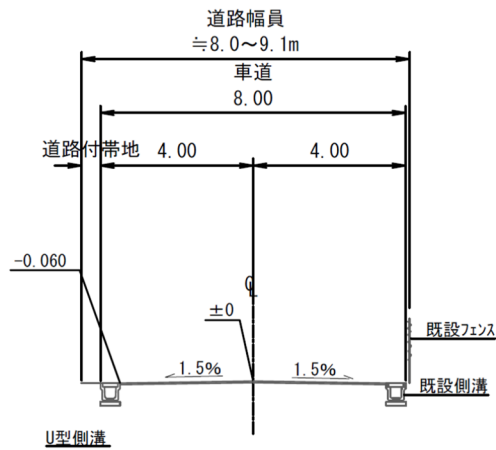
(5) 標準断面図(区画道路 8.5-1 幅員 8.0~9.1m)
